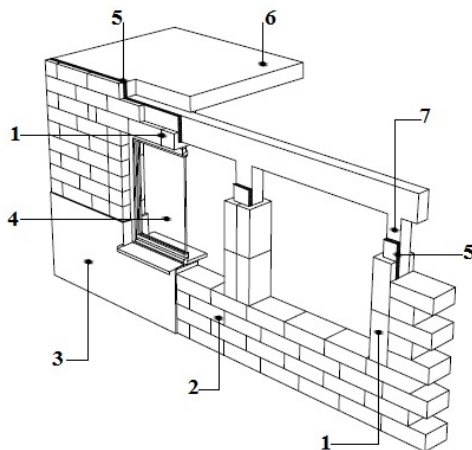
Схематический фасад наружной несущей стены: 1 — U-образные блоки; 2 — блоки YTONG; 3 — наружная отделка; 4 — оконный блок; 5 — минеральная вата; 6 — перекрытие; 7 — монолитный железобетон
